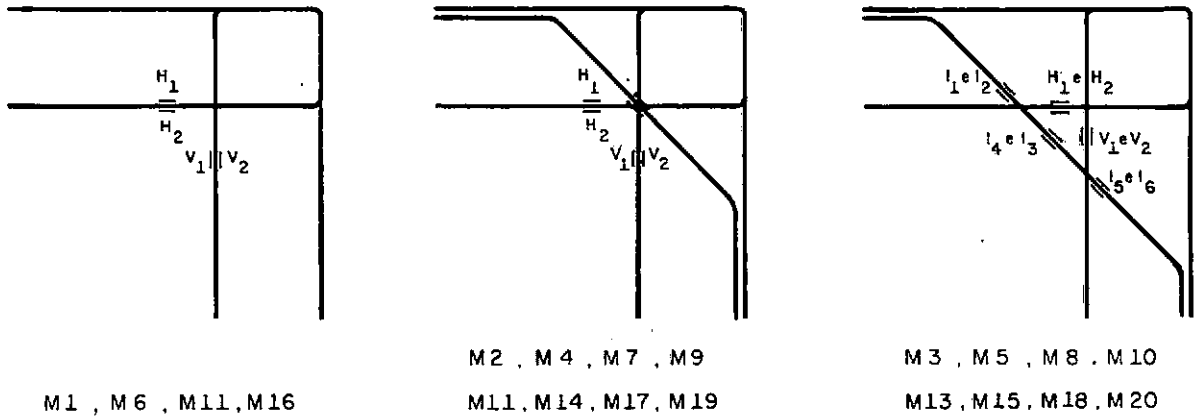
DISPOSIÇÃO DOS EXTENSÔMETROS NAS ARMADURAS
